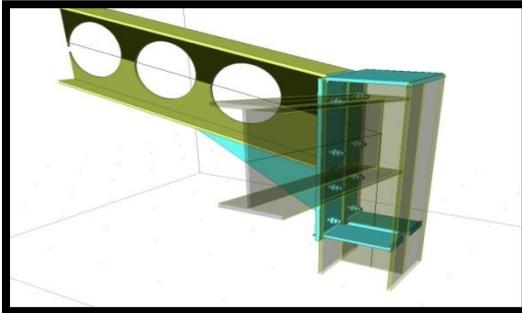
ASSEMBLAGE POTEAUX POUTRE
